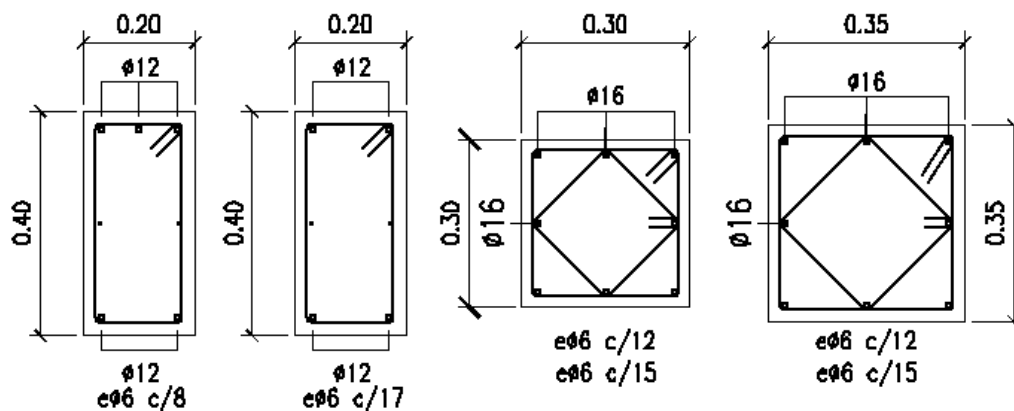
Secciones de viga V-301 y columnas C101 – C1
